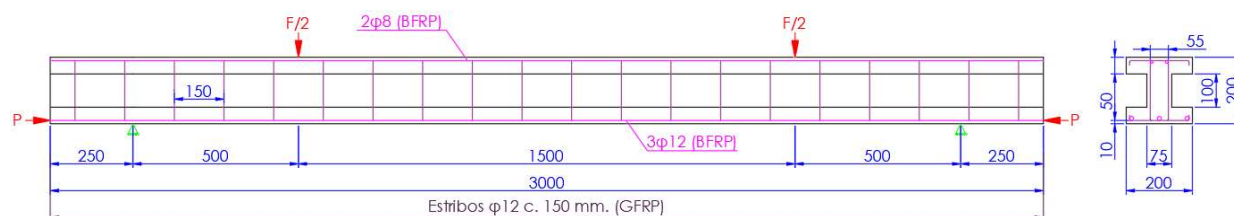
Esquema de configuración para viga H20CF (Dimensiones en milímetros)
